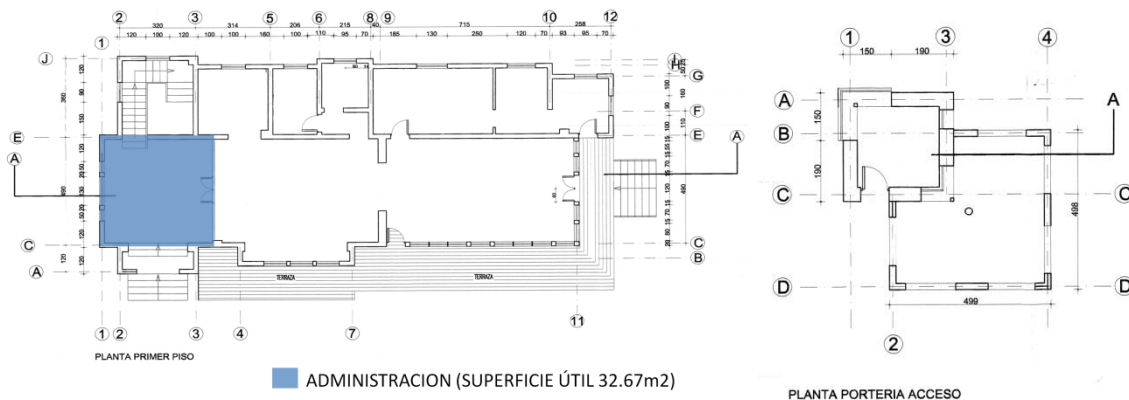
Planta de Primer Piso y Portería Acceso Casona Ex Sporting
